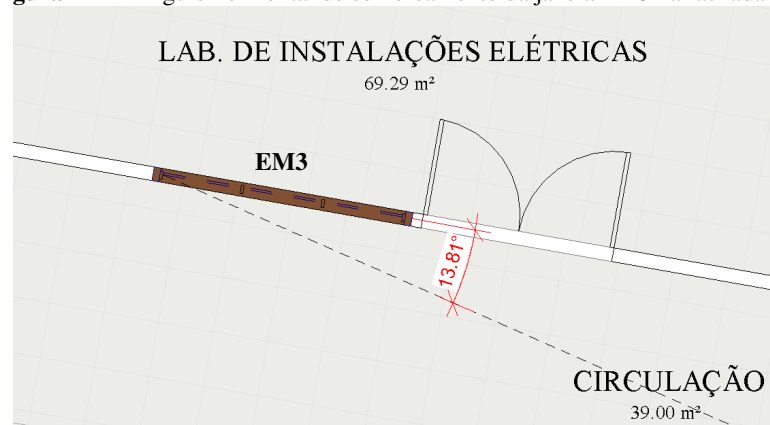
Ângulo horizontal de sombreamento da janela EM3-i na fachada sul
